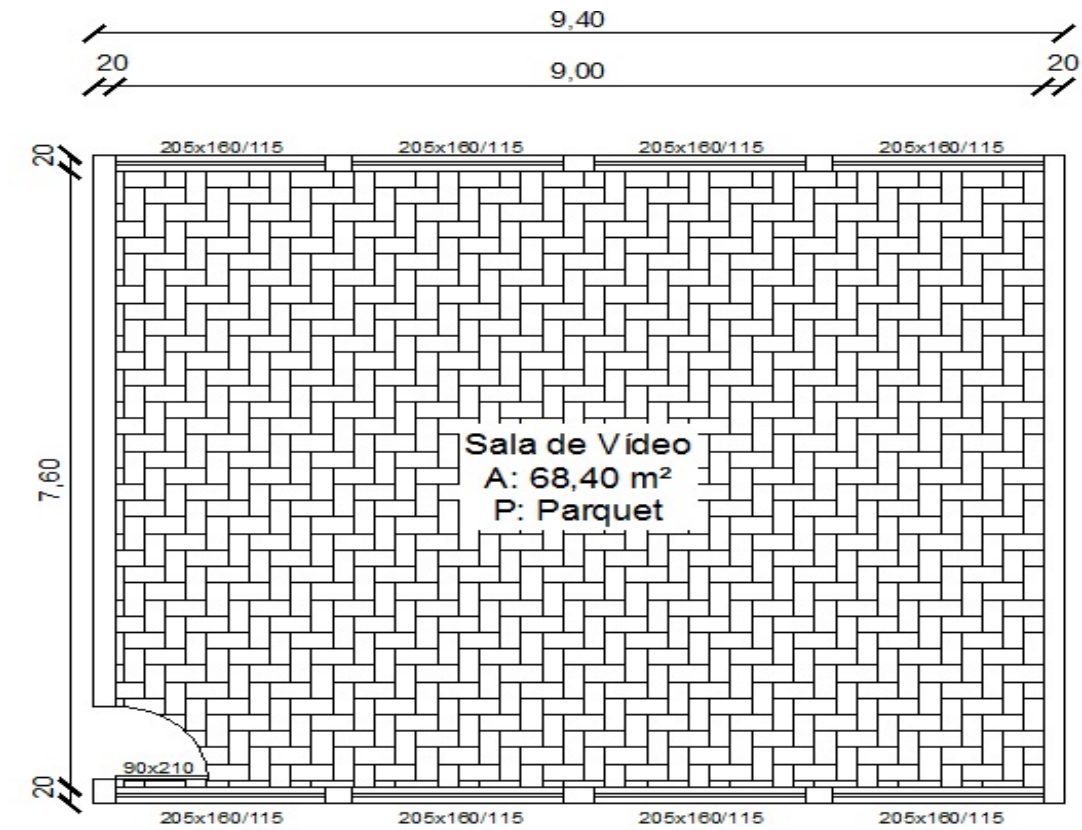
Planta baixa da sala de vídeo S3 (Projeto Próprio).
